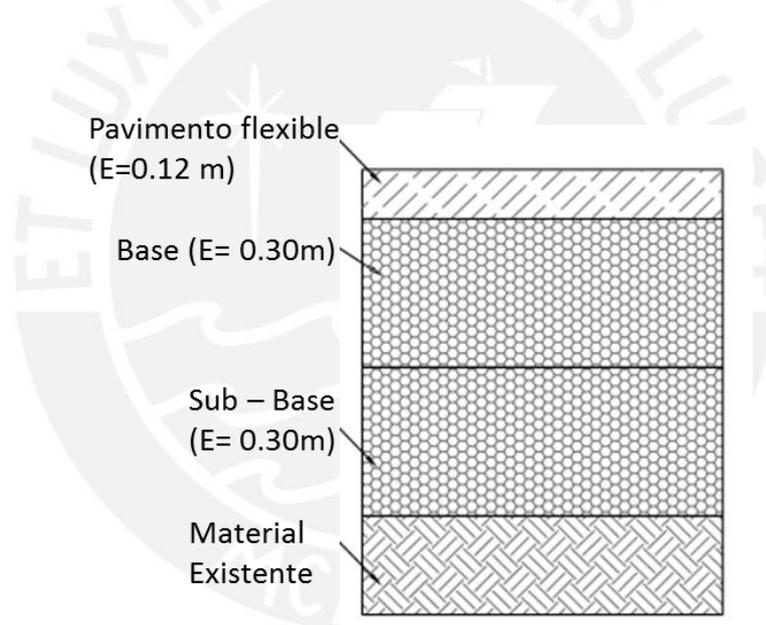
Ilustración del diseño del pavimento flexible perteneciente a la PS4
